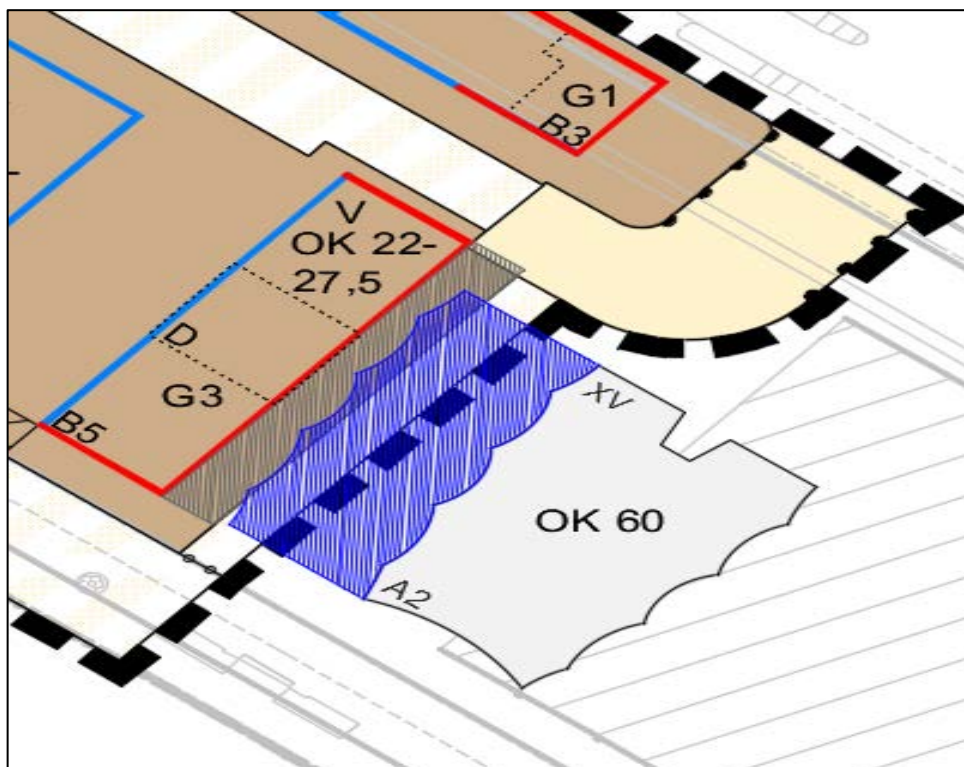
Darstellung der nachbarschützenden Abstandsfläche (0,3 H) für den im Bebauungsplan 2455 B geplanten Hochpunkt (Gebäude A2) und der nachbarschützenden Abstandsfläche (0,3 H) für das Baufeld B5
